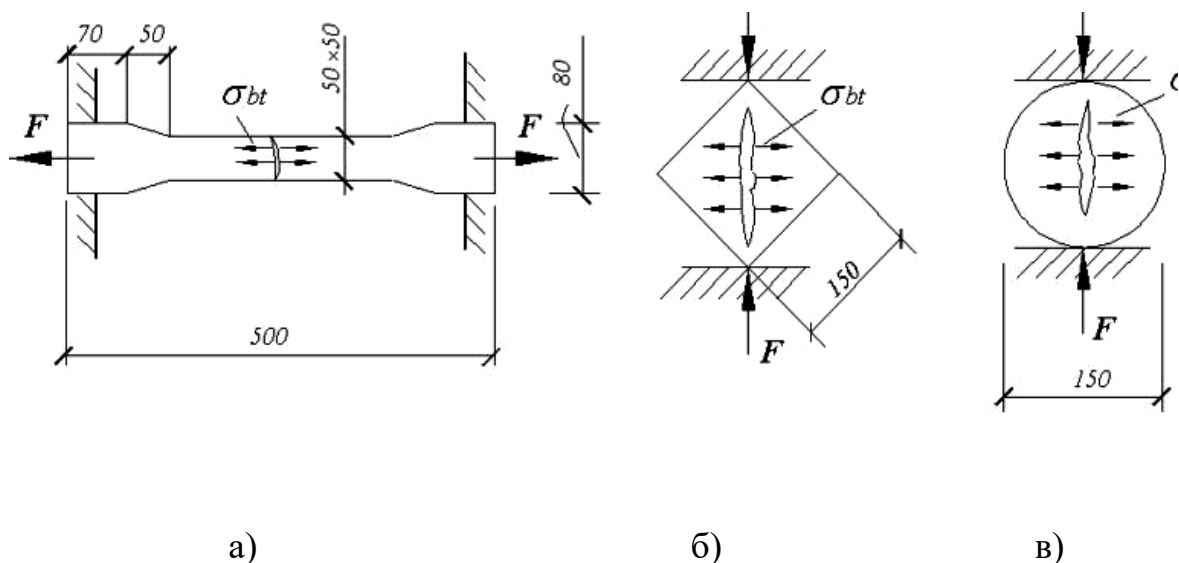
Схеми стандартних бетонних зразків для визначення міцності бетону при осьовому розтягу:
